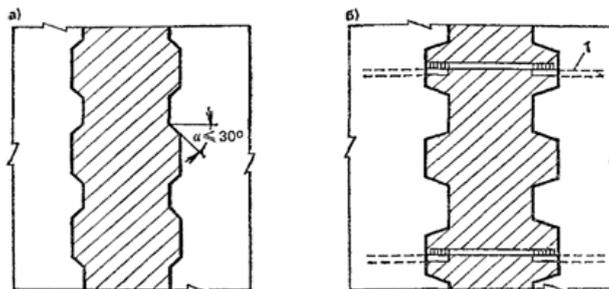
Железобетонные шпонки в вертикальных стыках стеновых панелей:
